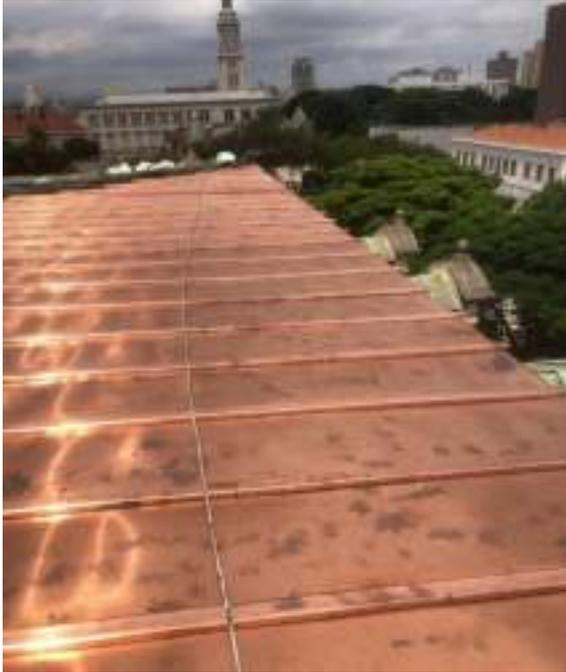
Conservação da cobertura, instalação de revestimento e alinhamento do caimento das águas da coberta.
